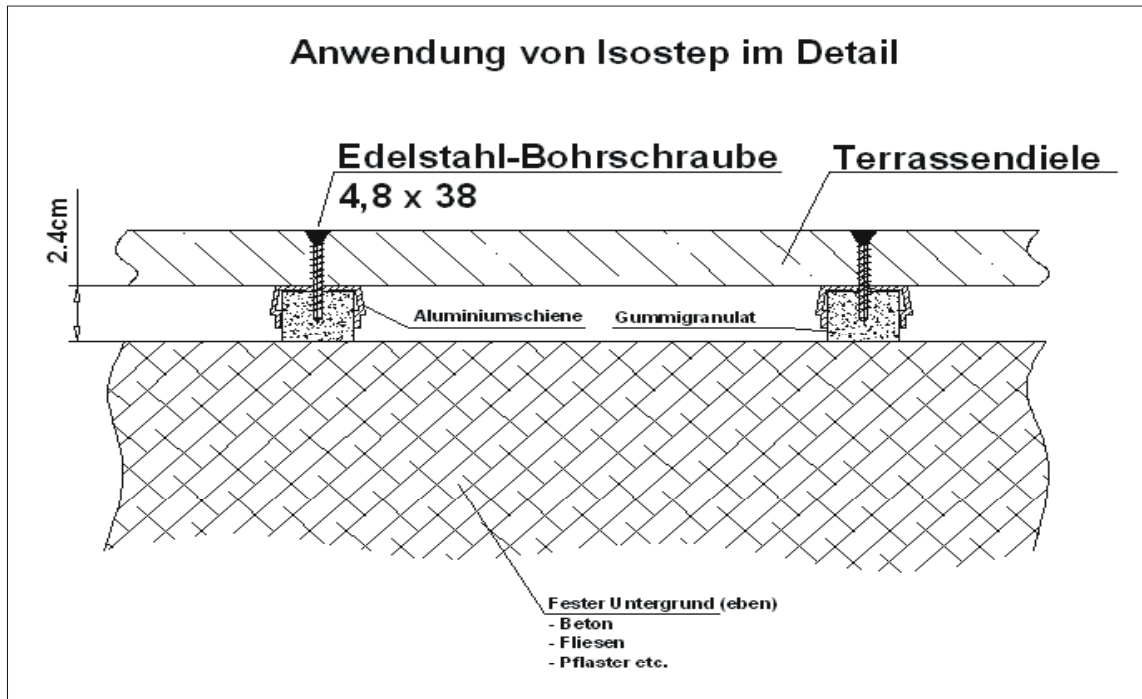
Aufbau mit System Isostep auf festem Untergrund
